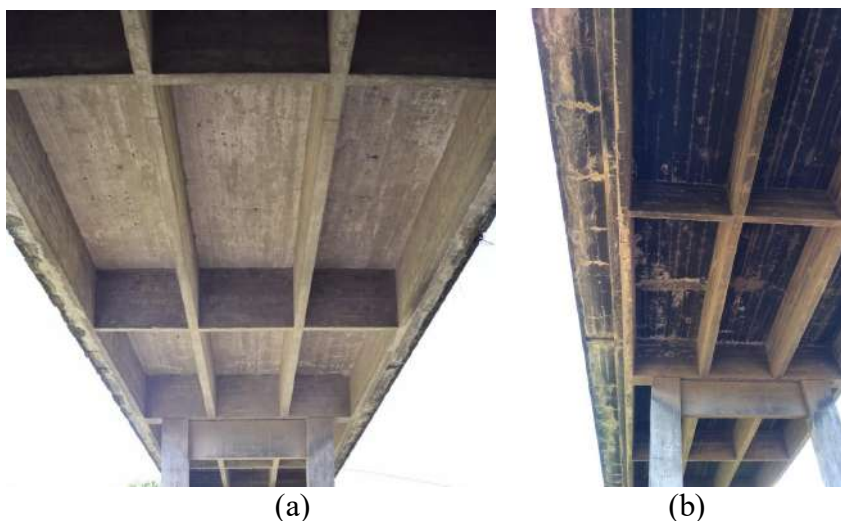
Tabuleiro de lajes maciças de concreto armado, travessas, longarinas e transversinas que compõem a estrutura do viaduto.
